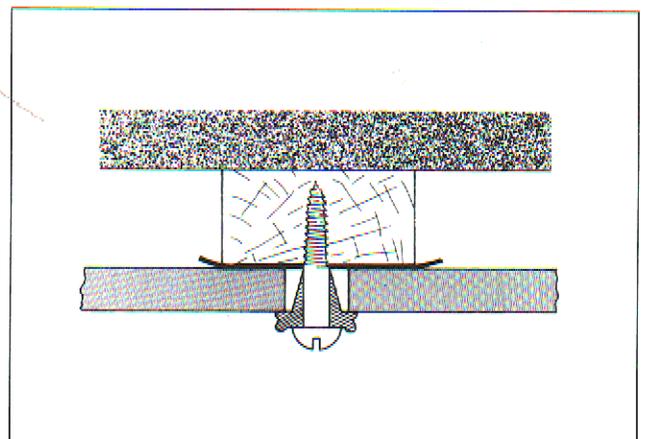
Mittelbefestigung mit HPL-Montageschrauben auf Holz-Unterkonstruktion mit Fugenband-Hinterlegung
